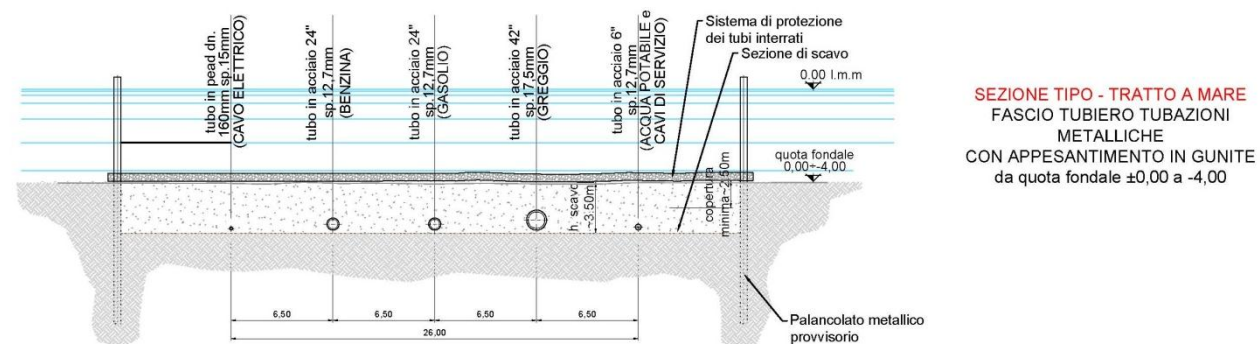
Fascio tubiero - tratto a mare : sezione di posa fino da quota fondale 0.00 a -4.00 m slmm
